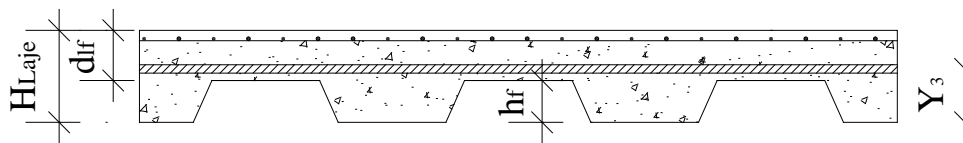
Detalhes da laje tipo *Steel Deck
